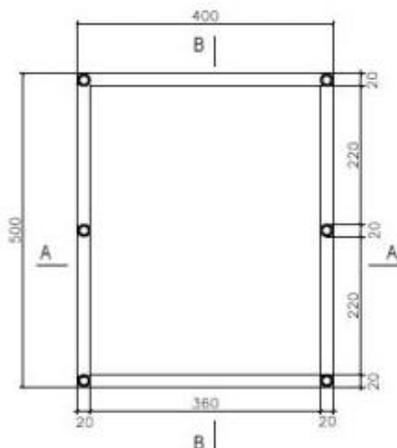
Planta Baixa e estrutura da edificação, 2018.
